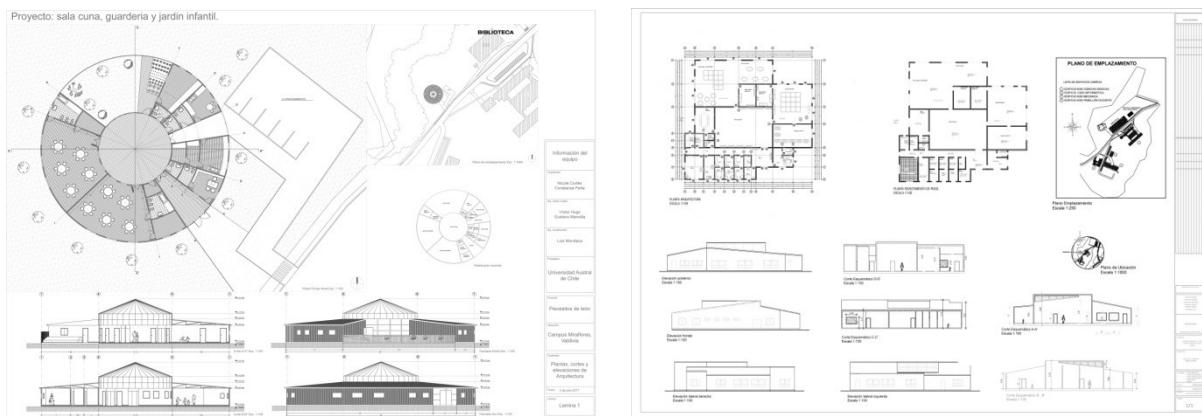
Plantas arquitectónicas. Propuesta planta redonda y cuadrada.
